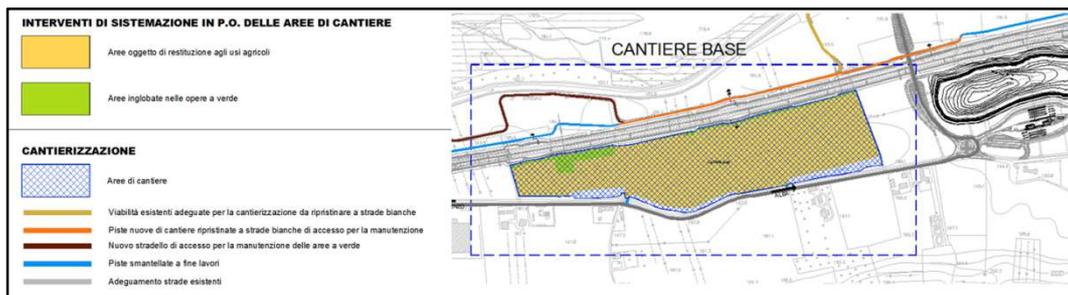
Stralcio Planimetria 2.6E-dF.2.1.53-00 Cantierizzazione - Corografia piste di cantiere interventi di ripristino
